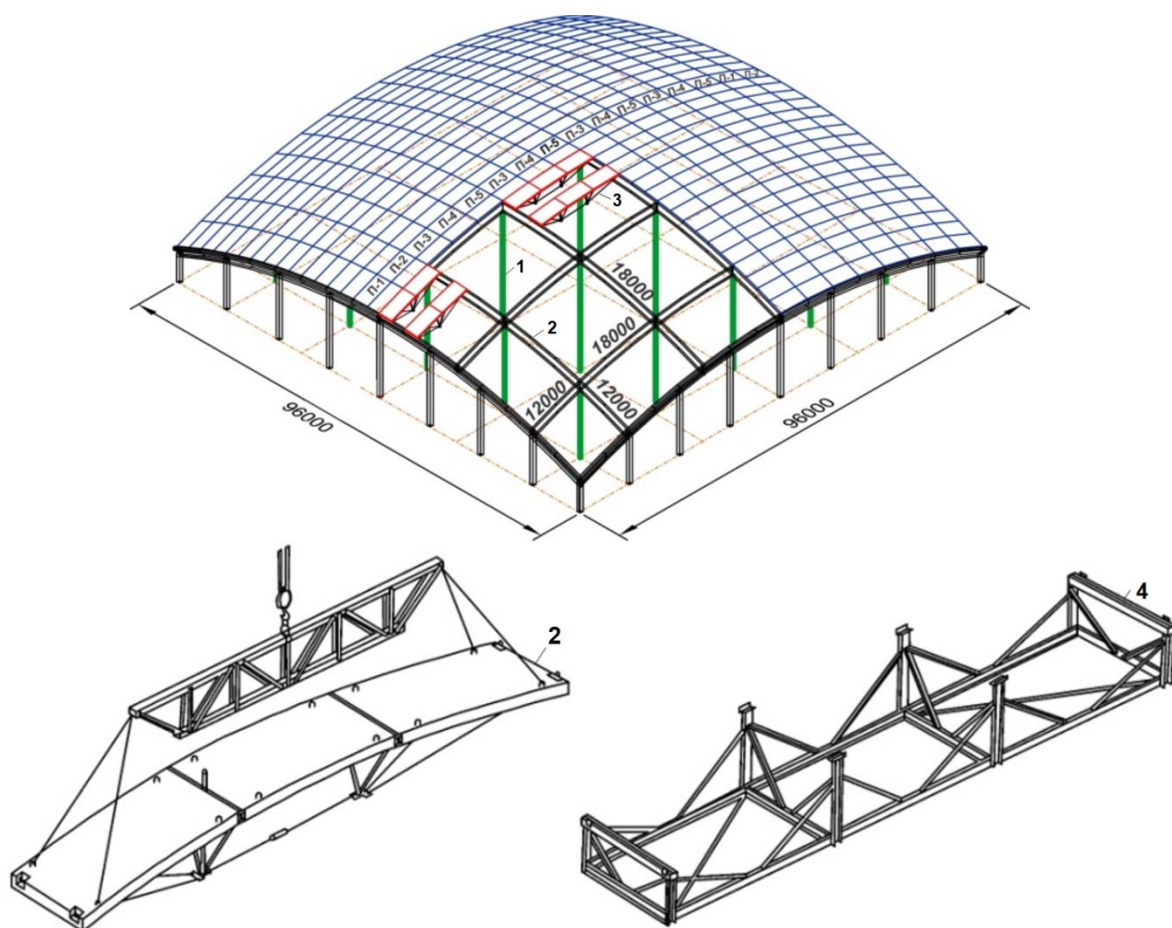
Монтажные стадии опытных большепролетных уникальных зданий с укрупненной монтажной секцией. 1-монтажные стойки; 2 - перекрестные балки жесткости; 3 - монтажная секция; 4 - стенд для укрупнительной сборки.
